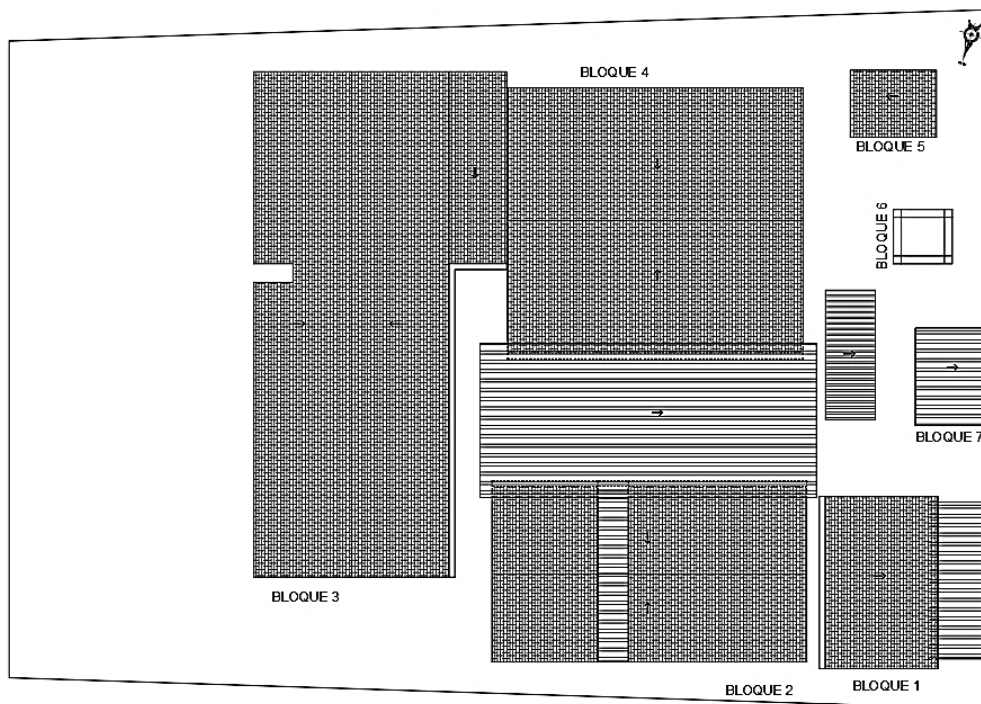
PLANO DE PLANTA DEL EE.SS. I – 4 PAIMAS
